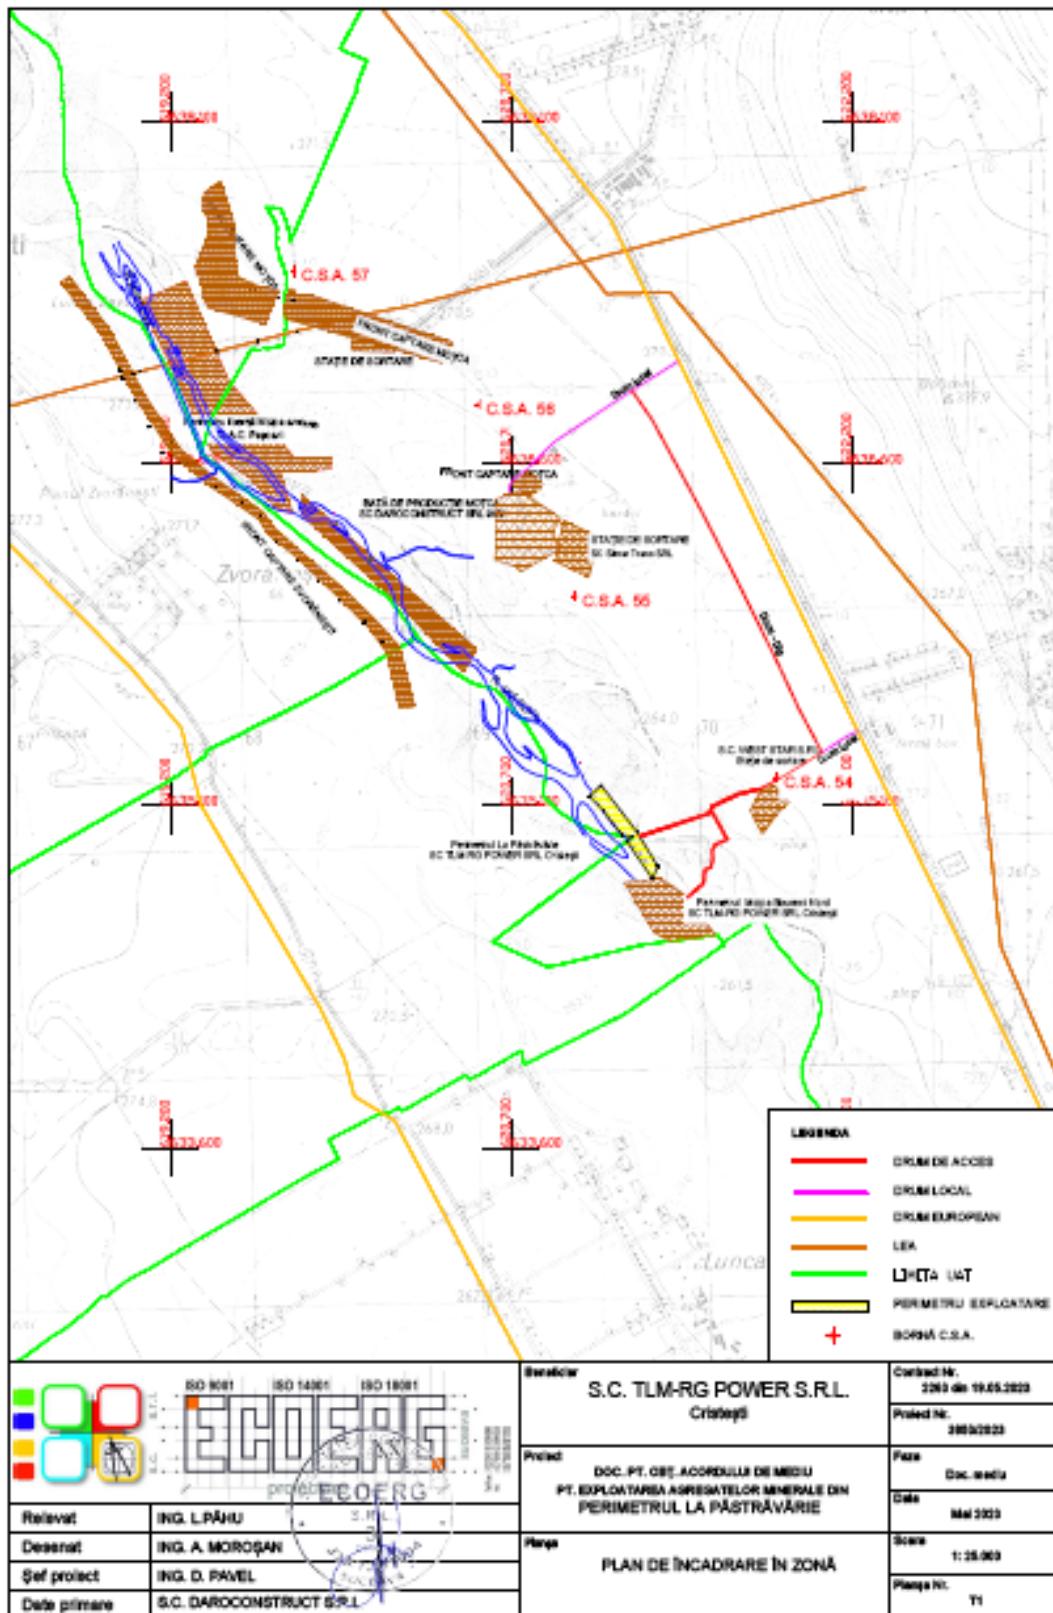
Plan de încadrare în zonă perimetru La Păstrăvărie
